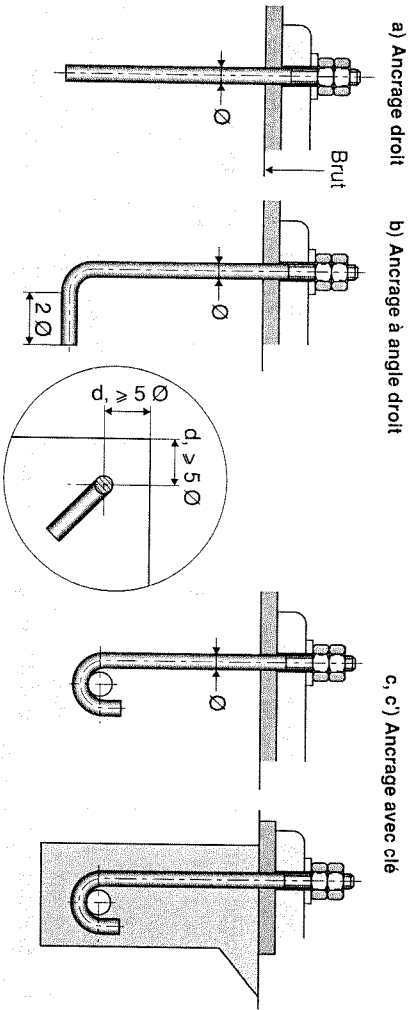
Tiges d'ancrage mises en place avant ou après coulage.
